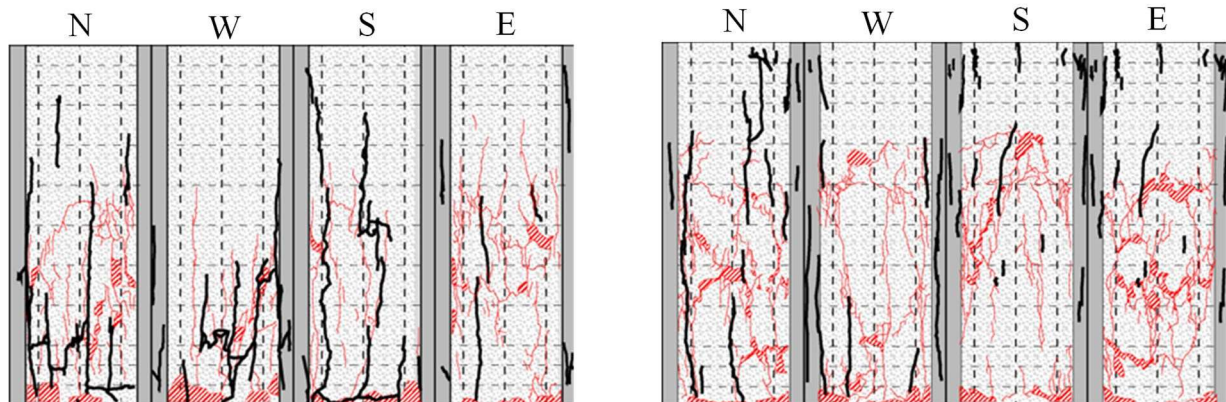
ひび割れ状況(補強後 RC 柱)
